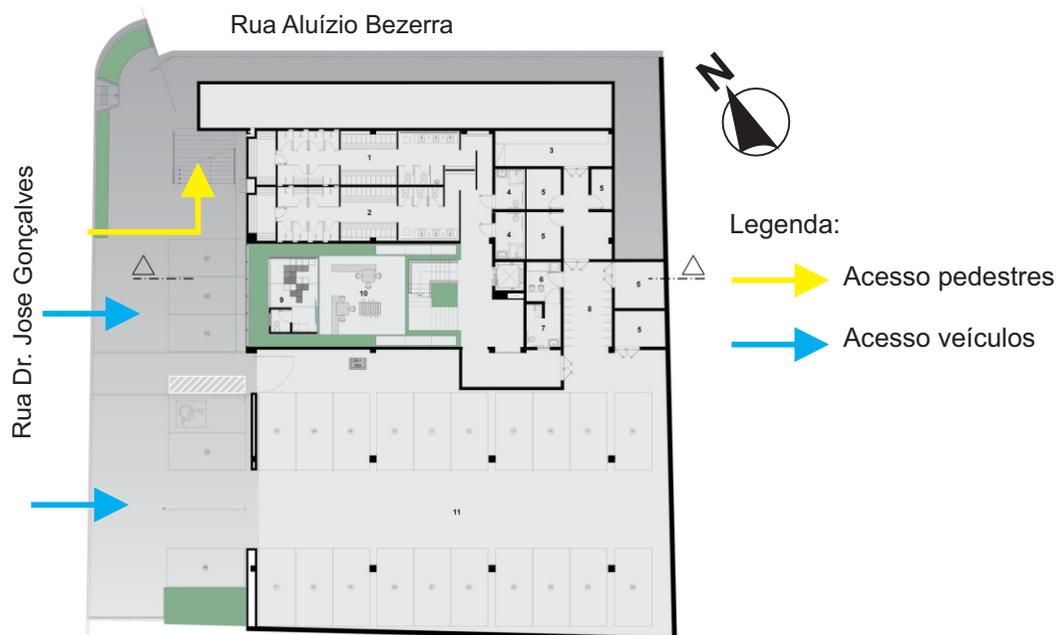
Planta baixa Subsolo. Fonte: Site Archdaily
